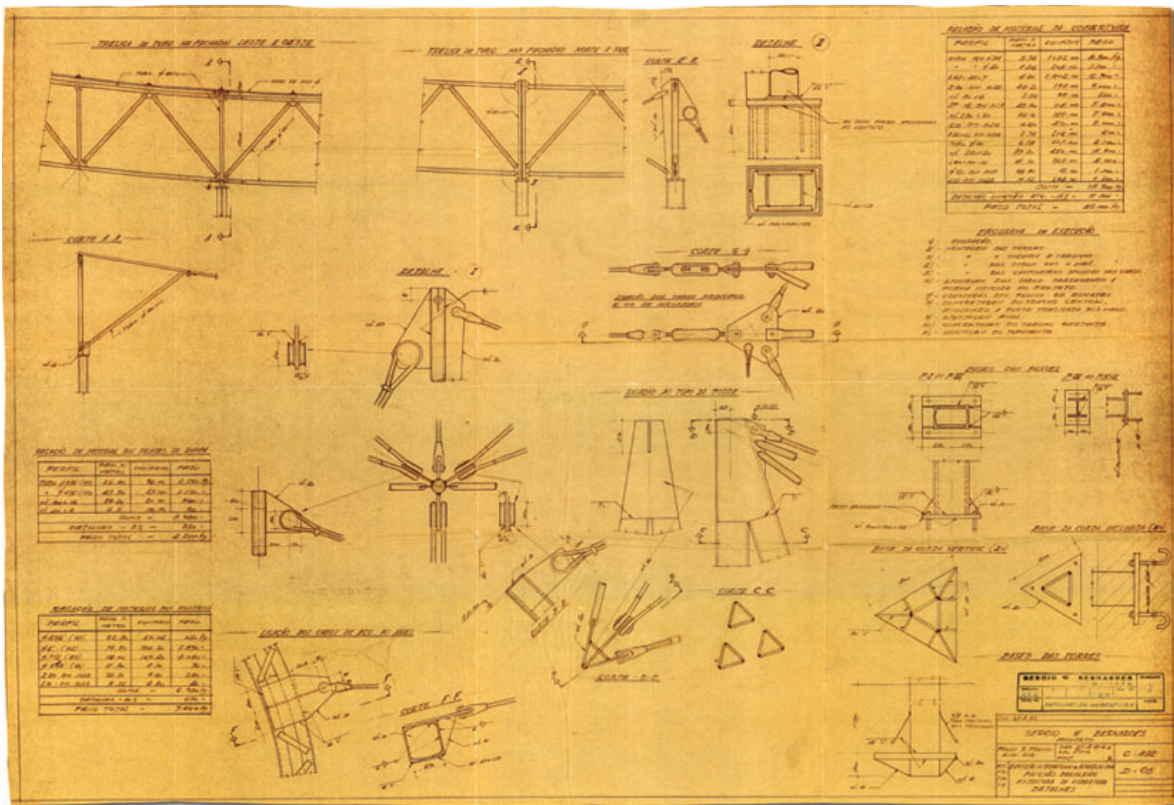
Lámina del Proyecto estructural del Pabellón de Brasil en la Exposición Universal de Bruselas (1958) sellada por el Ingeniero Paulo Fragoso y por el arquitecto Sergio Bernardes. Detalles de la cubierta.
